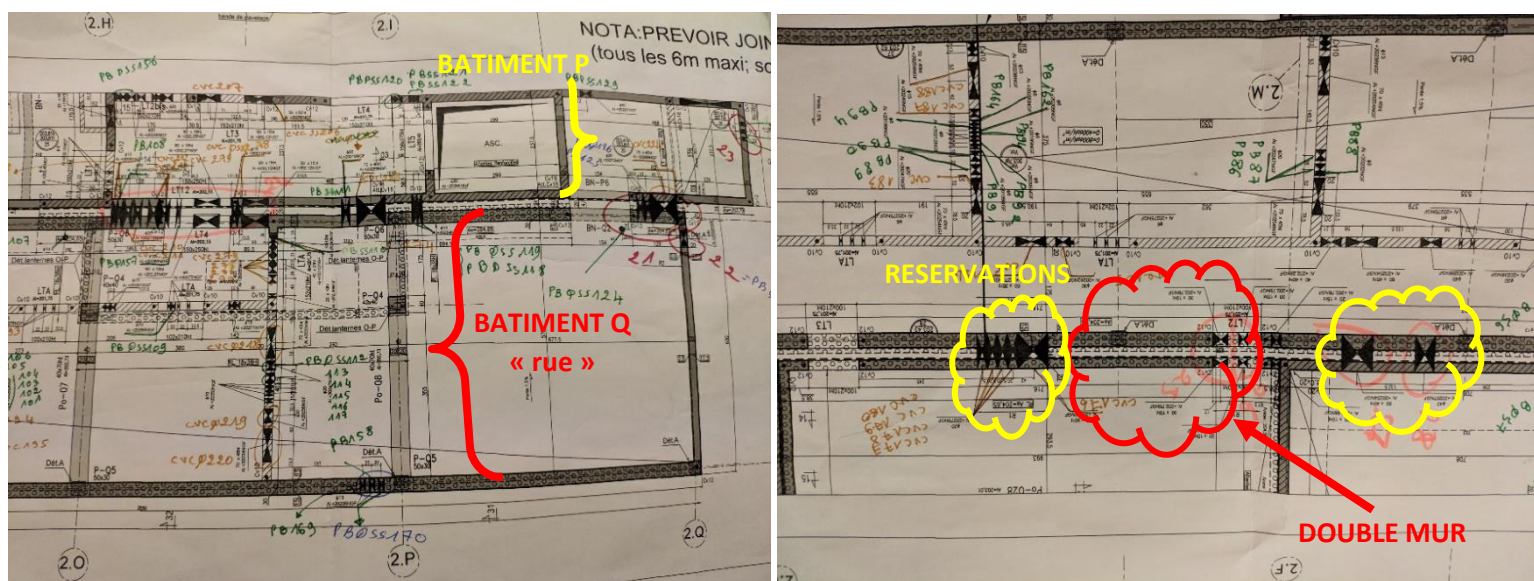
extraits de plan de coffrage (sous-sol du bâtiment Q « rue »).
